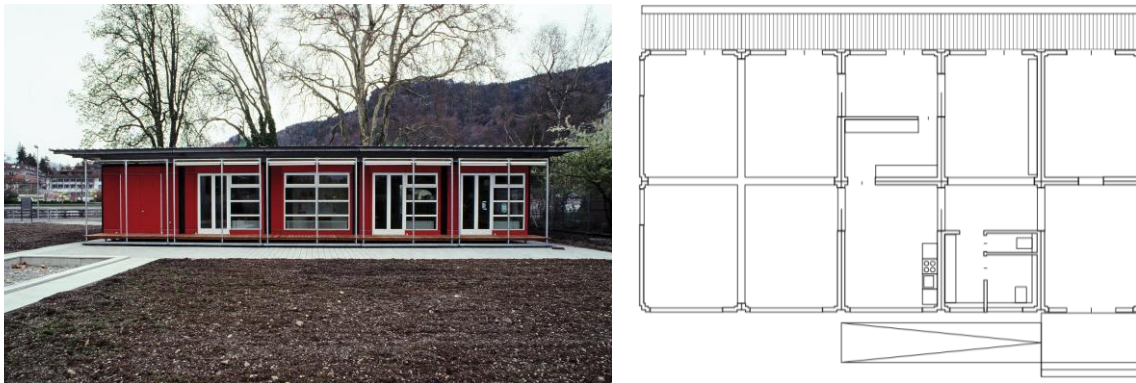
Modular Thun, Bild und Grundriss / Bauart Architekten und Planer AG
